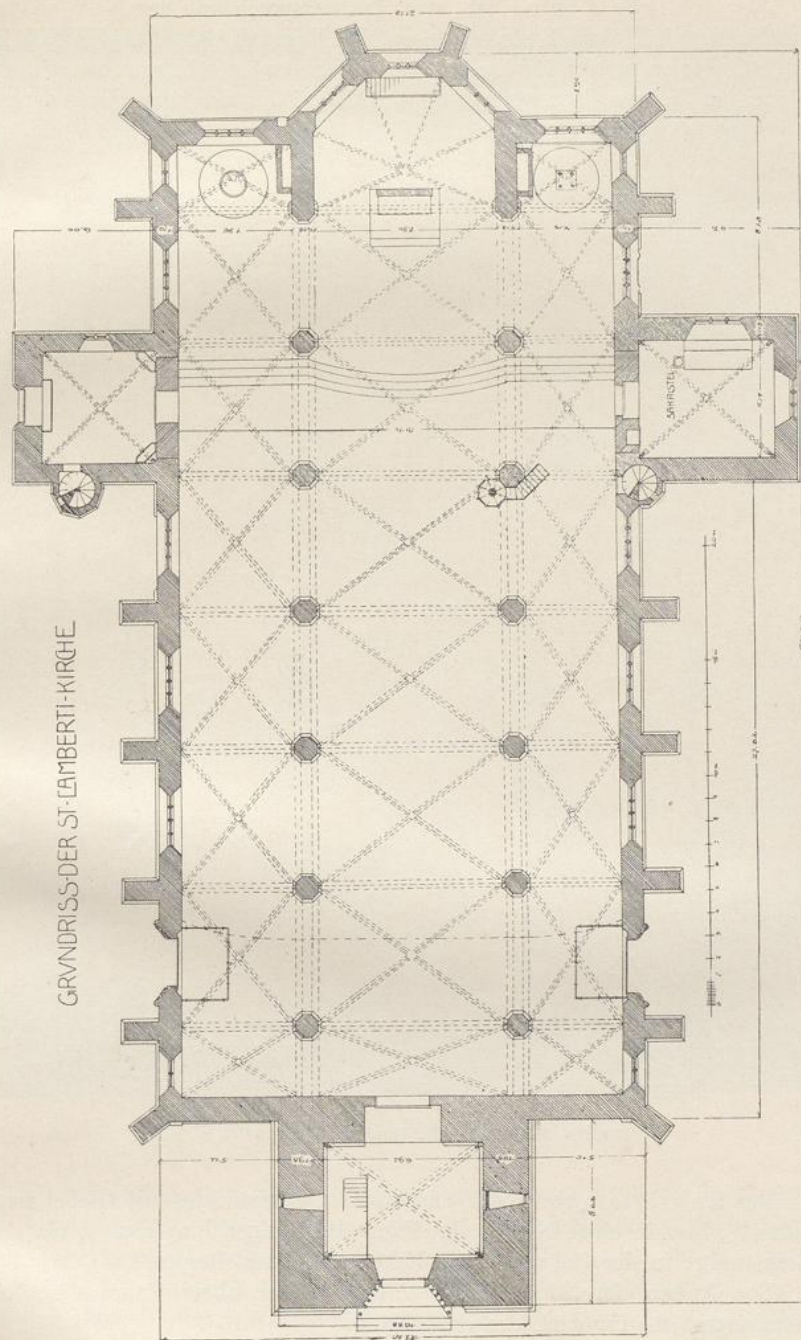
Hildesheim. St. Lambert. Grundriss.
